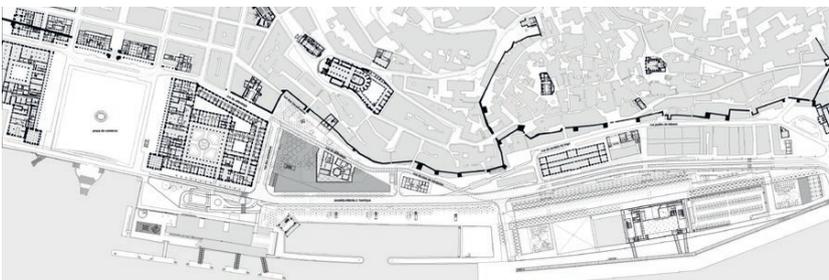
Planimetria del lungofiume dalla Praça do Comercio ai Jardim do Tabaco, Terreiro do Trigo e Terminal Crociere. gentile concessione di @Global Arquitectura Paisagista.
